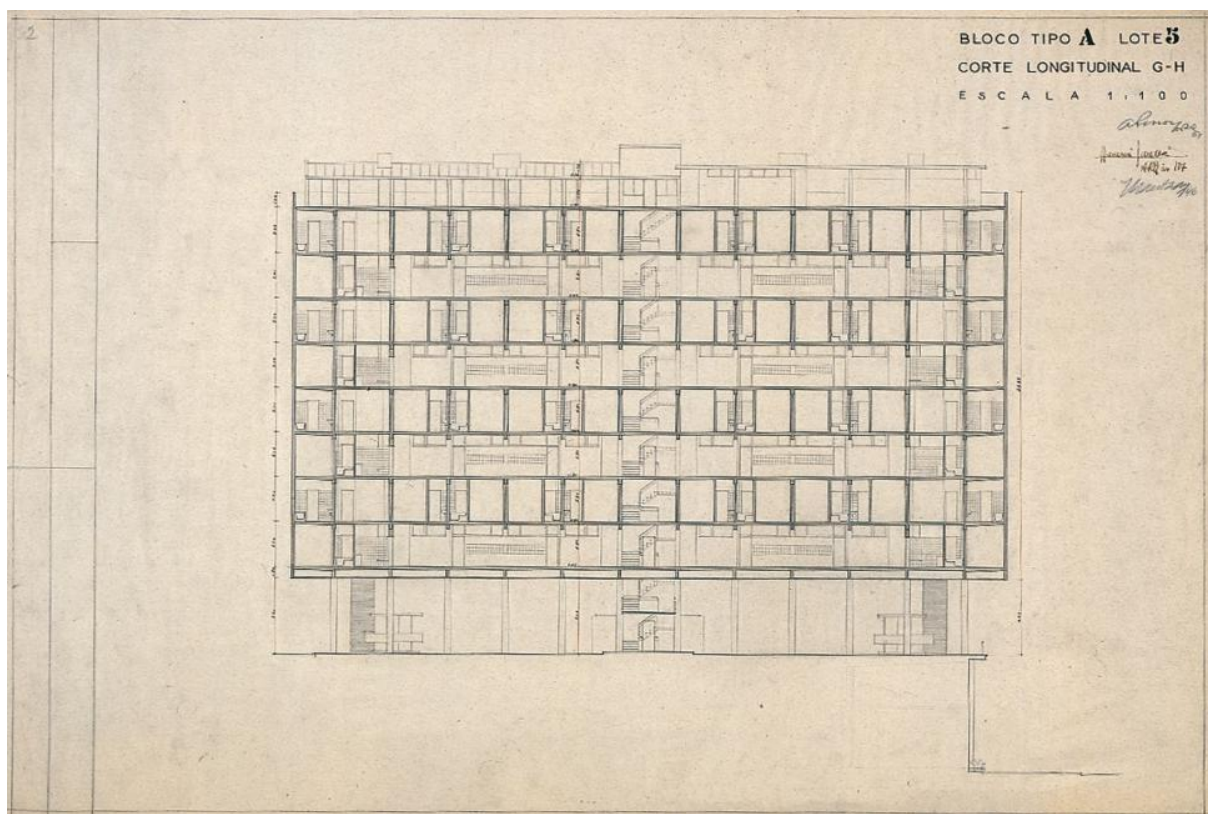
Corte longitudinal Lote 5 (Projeto 1952-1955) (Pessoa, 1940).
